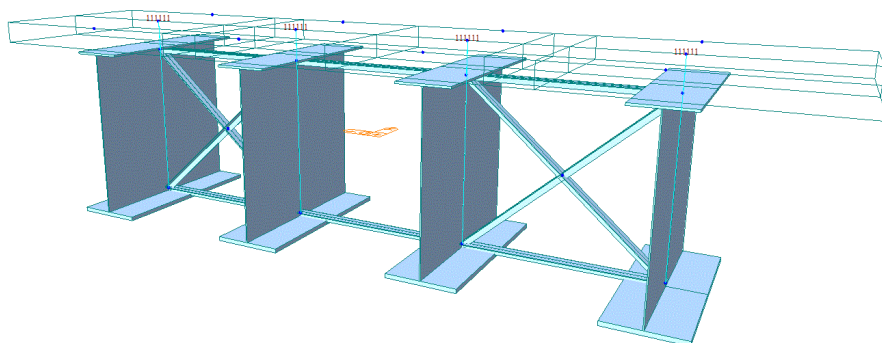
Collegamento tra travi e elementi trasversali – vista estrusa
